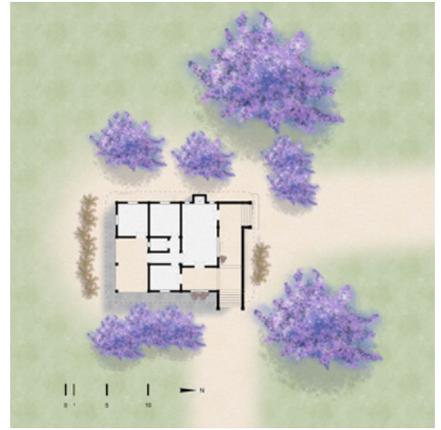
Planta arquitectónica de la Casita de Piedra. Fuente: dibujo de Libertad Castillo y Daniel García Barrera.
